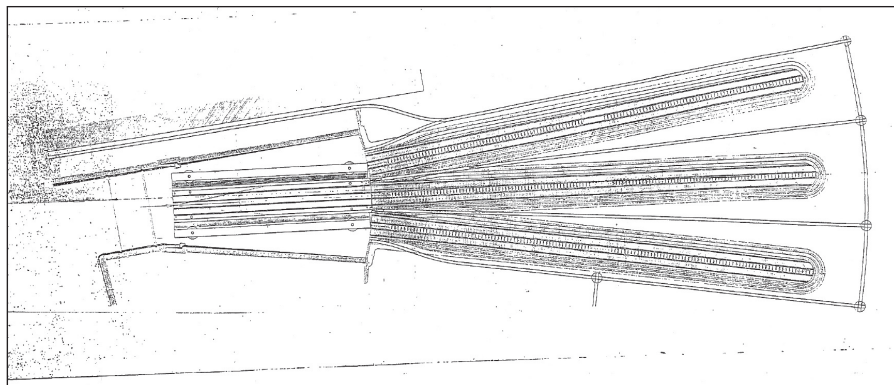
Plano del proyecto de varadero de plano horizontal.
